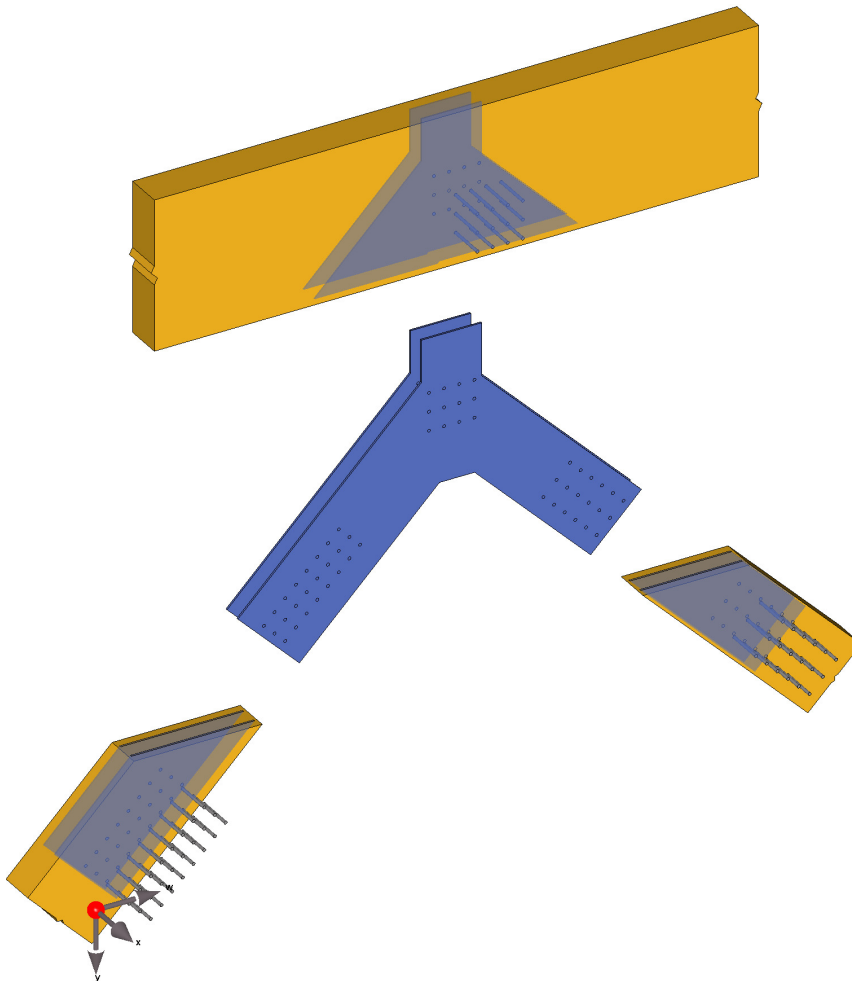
Explosionszeichnung des Anschlusses für Fachwerk FB2.j
